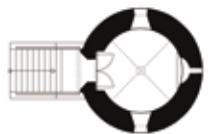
Grundriss Stubtsch/Tax 2009. M 1:400.
